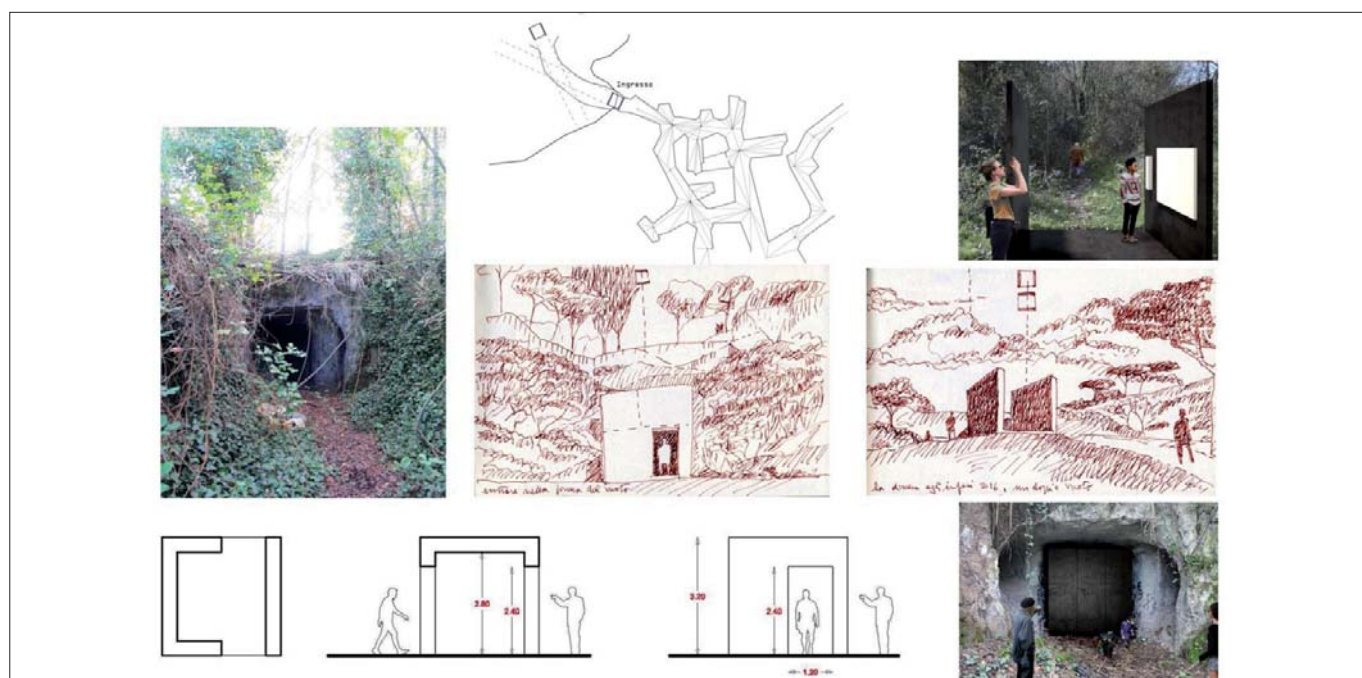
Cave del Parco della Caffarella. Architetture minime di ingresso alle cave e di introduzione alla fruizione: planimetria, pianta, sezioni, fotoinserimenti, disegni di studio (schizzi di L. Montuori)
